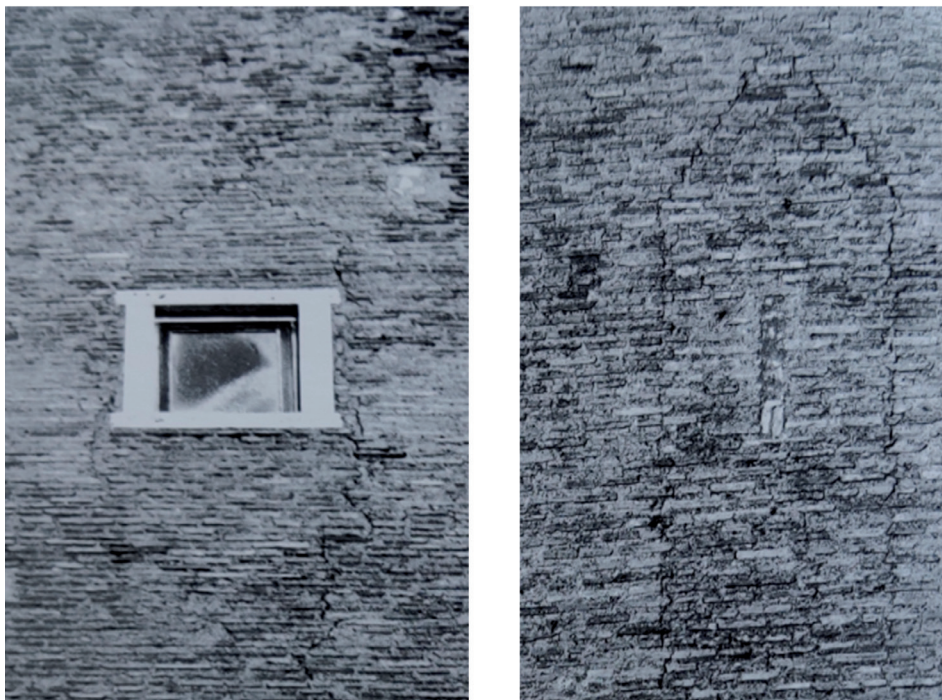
Finestra a capanna poi tamponata nel prospetto sud-ovest; finestra a capanna tamponata, con all'interno una feritoia anch'essa poi tamponata nel prospetto sud-est (da Bianchi, «La Torre»).
